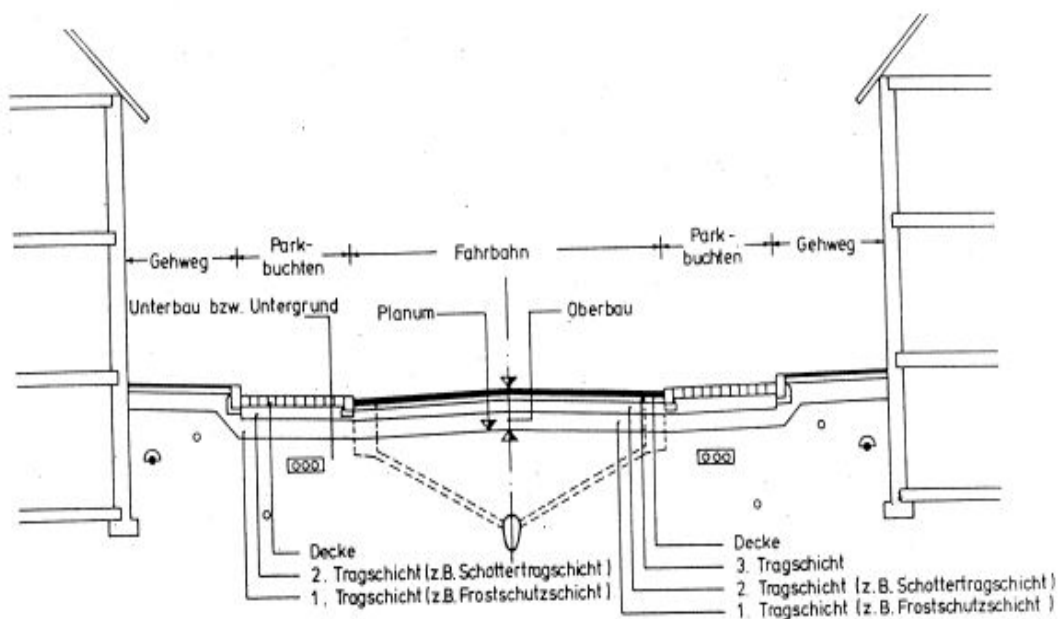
In geschlossener Ortslage mit wasserundurchlässigen Randbereichen und geschlossener seitlicher Bebauung sowie mit Entwässerungseinrichtungen
